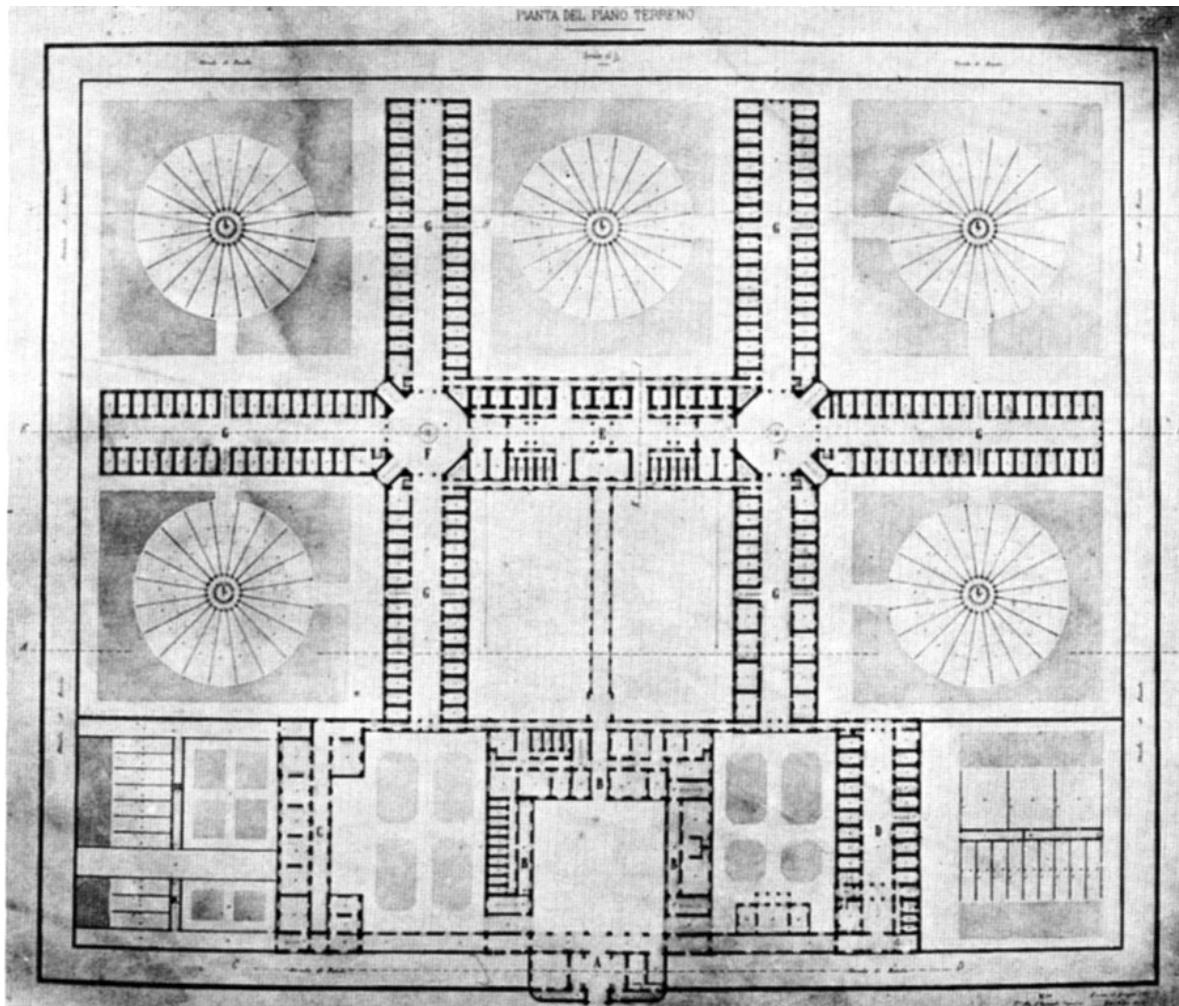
Giuseppe Polani, Progetto del carcere Le nuove, 1861. *Pianta piano terreno*. Archivio Storico della Città di Torino.
